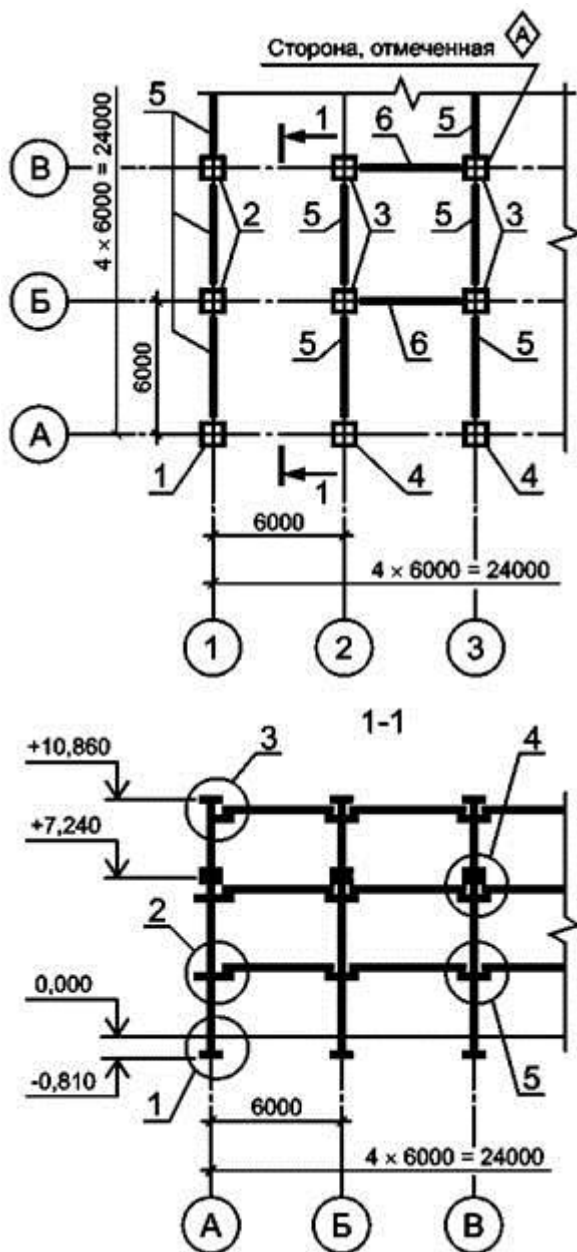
Схема расположения колонн, ригелей и балок перекрытия
